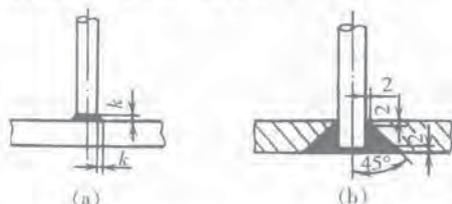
预埋件钢筋电弧焊 T 型接头
